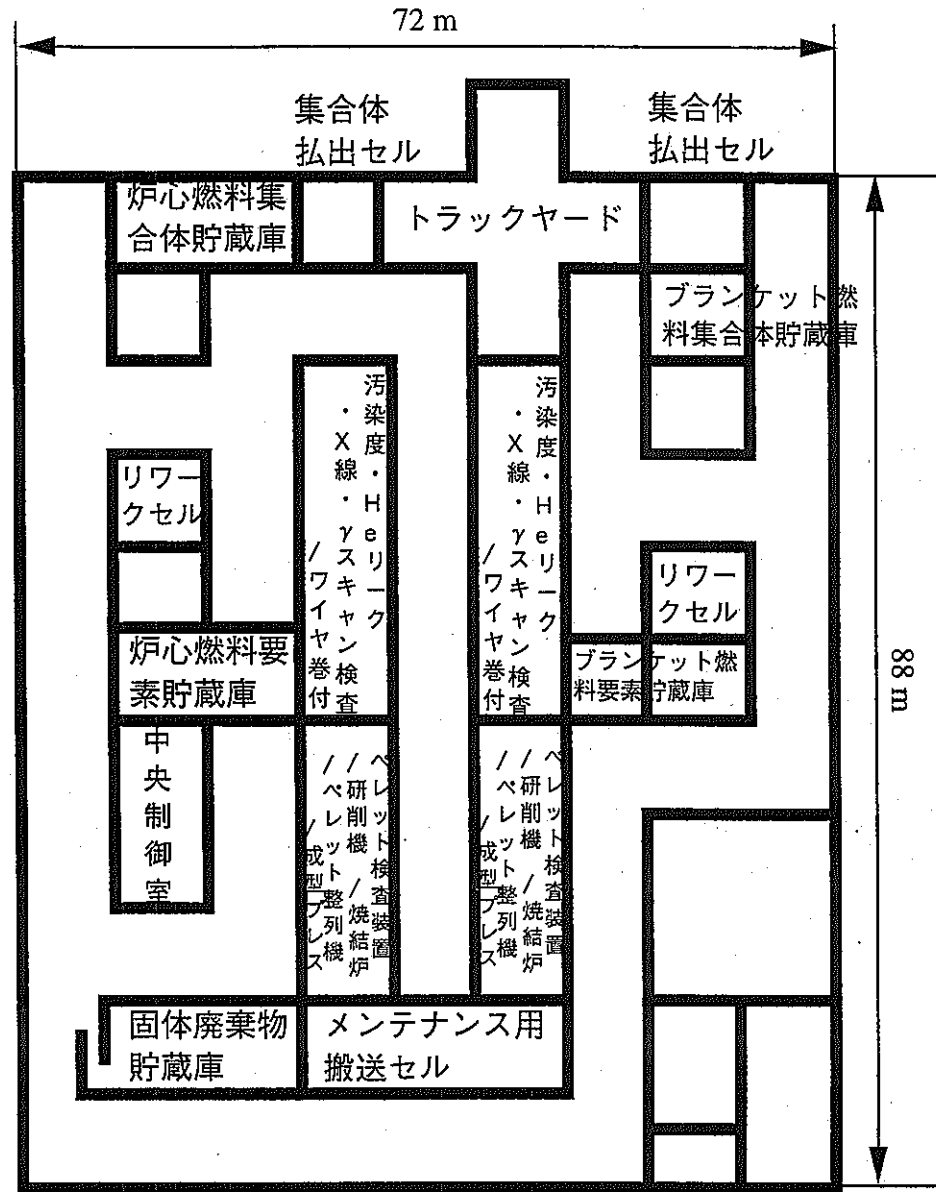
低除染/ペレット燃料製造プラント セル内機器配置図 (50tHM) 1F 平面
